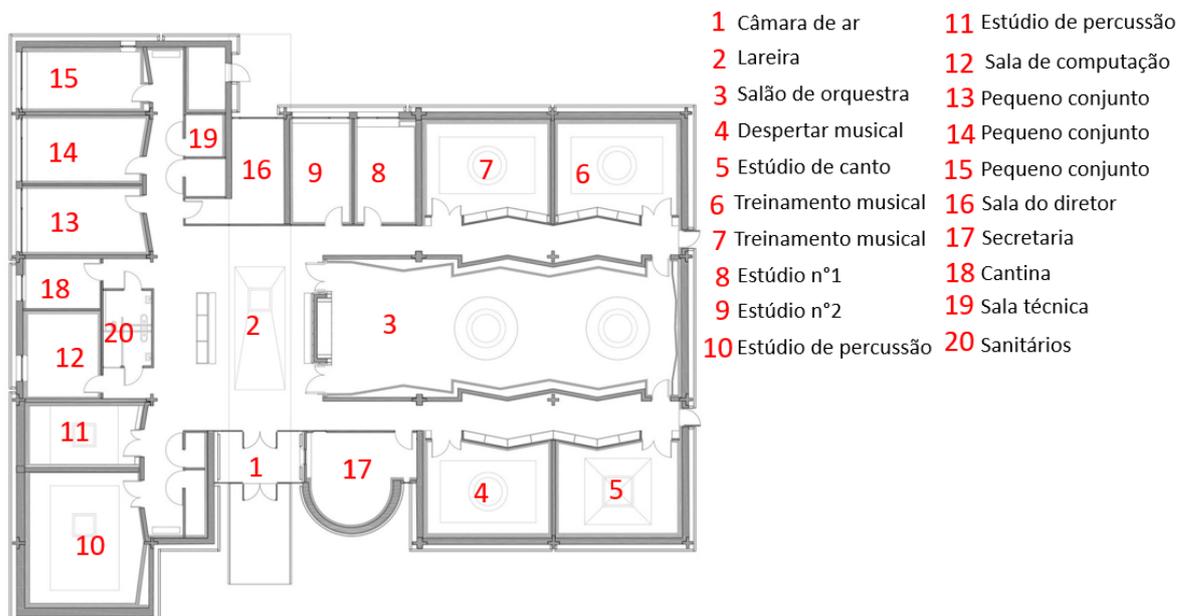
Planta baixa da Élan court. Fonte: Adaptado de Archdaily, 2018.
